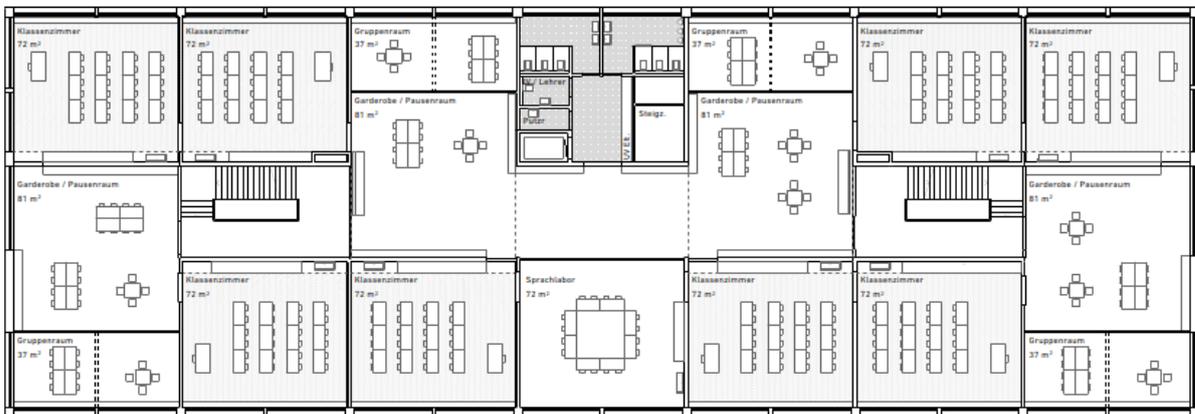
Grundriss 3. Obergeschoss
